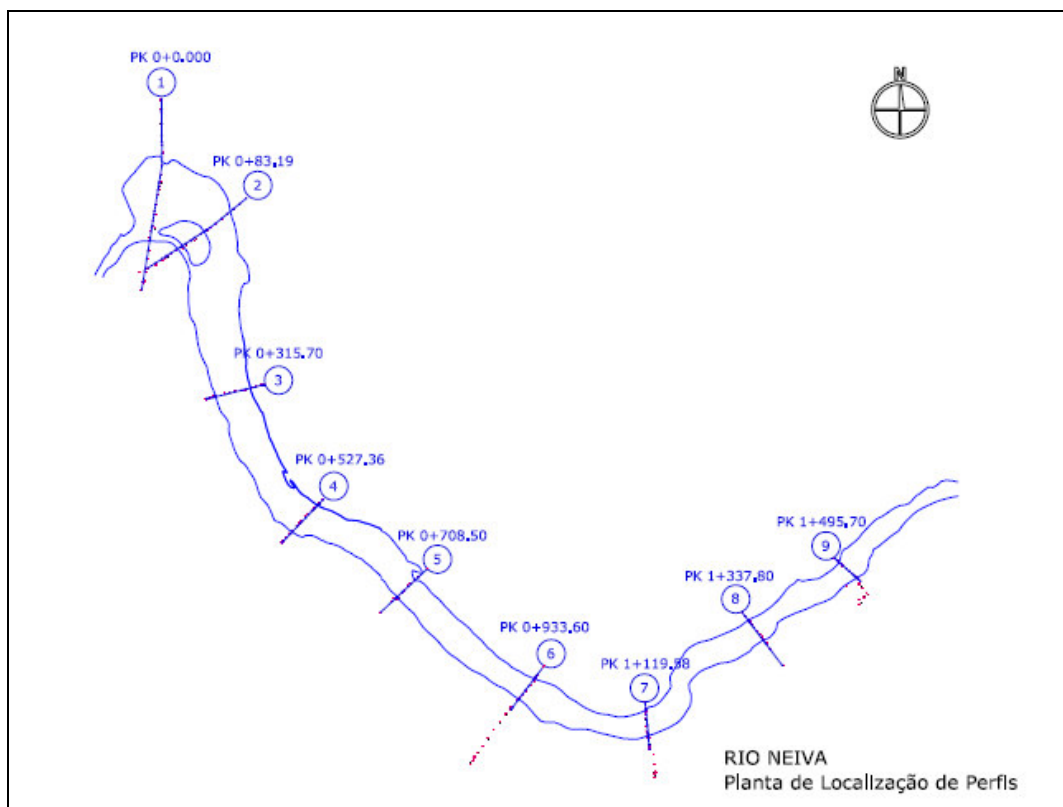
Traçado do rio Neiva em planta com as secções transversais consideradas (1 a 9).
